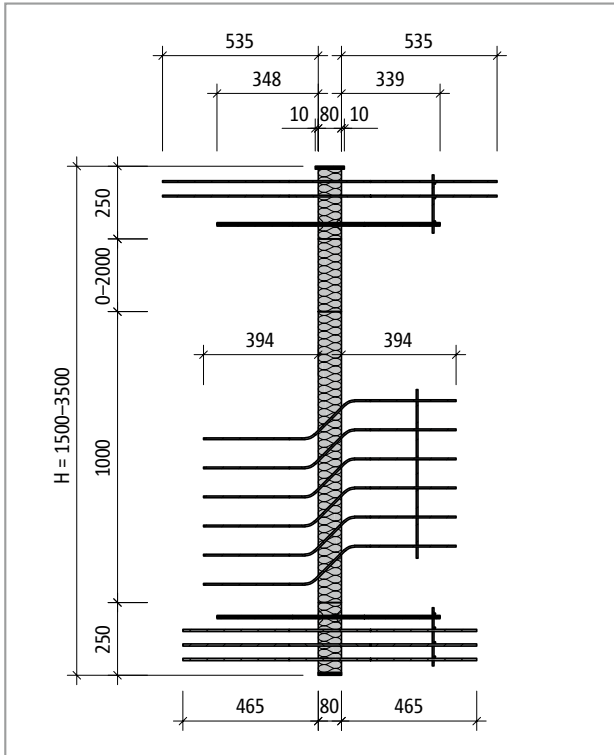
Schöck Isokorb® T type W-M1-R90: Product layout; Fire protection board top and bottom
